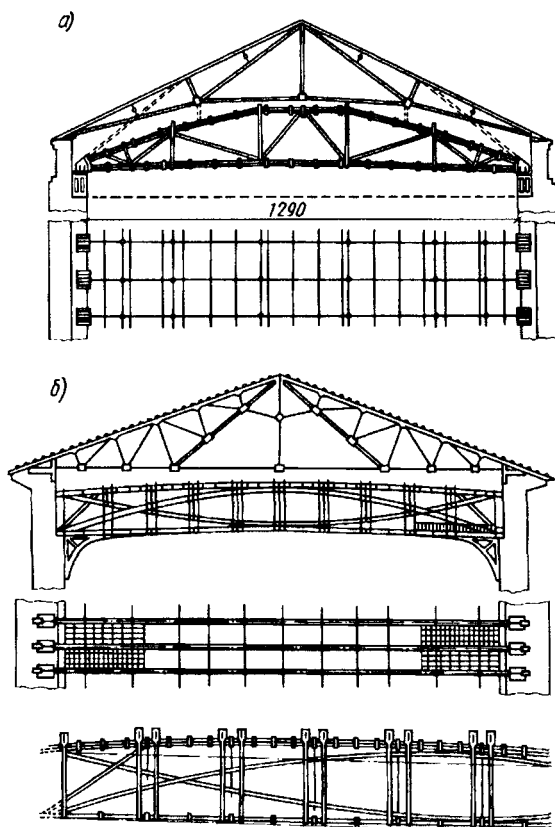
Перекрытие Зимнего дворца в Петербурге
